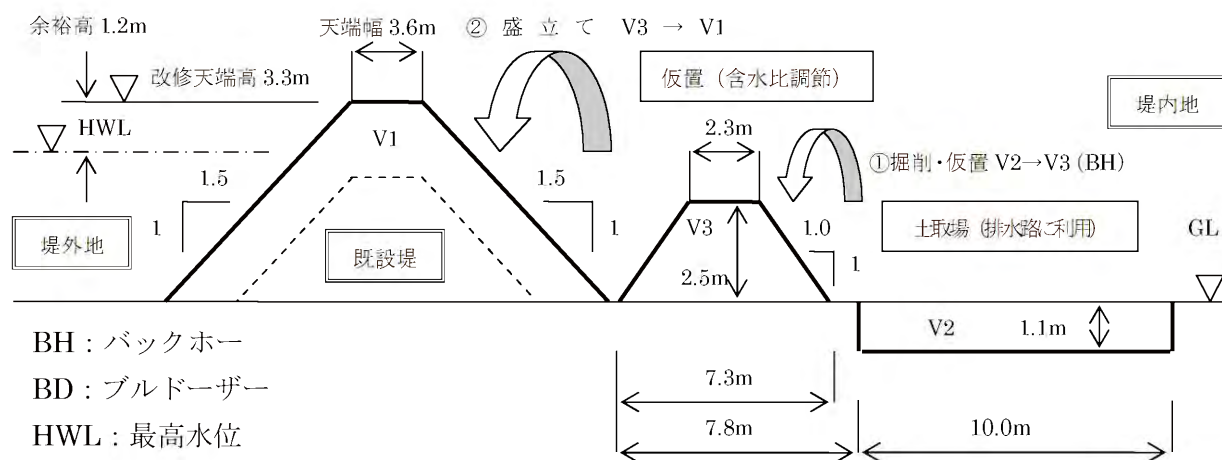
堤防復旧計画及び施工計画標準断面図
